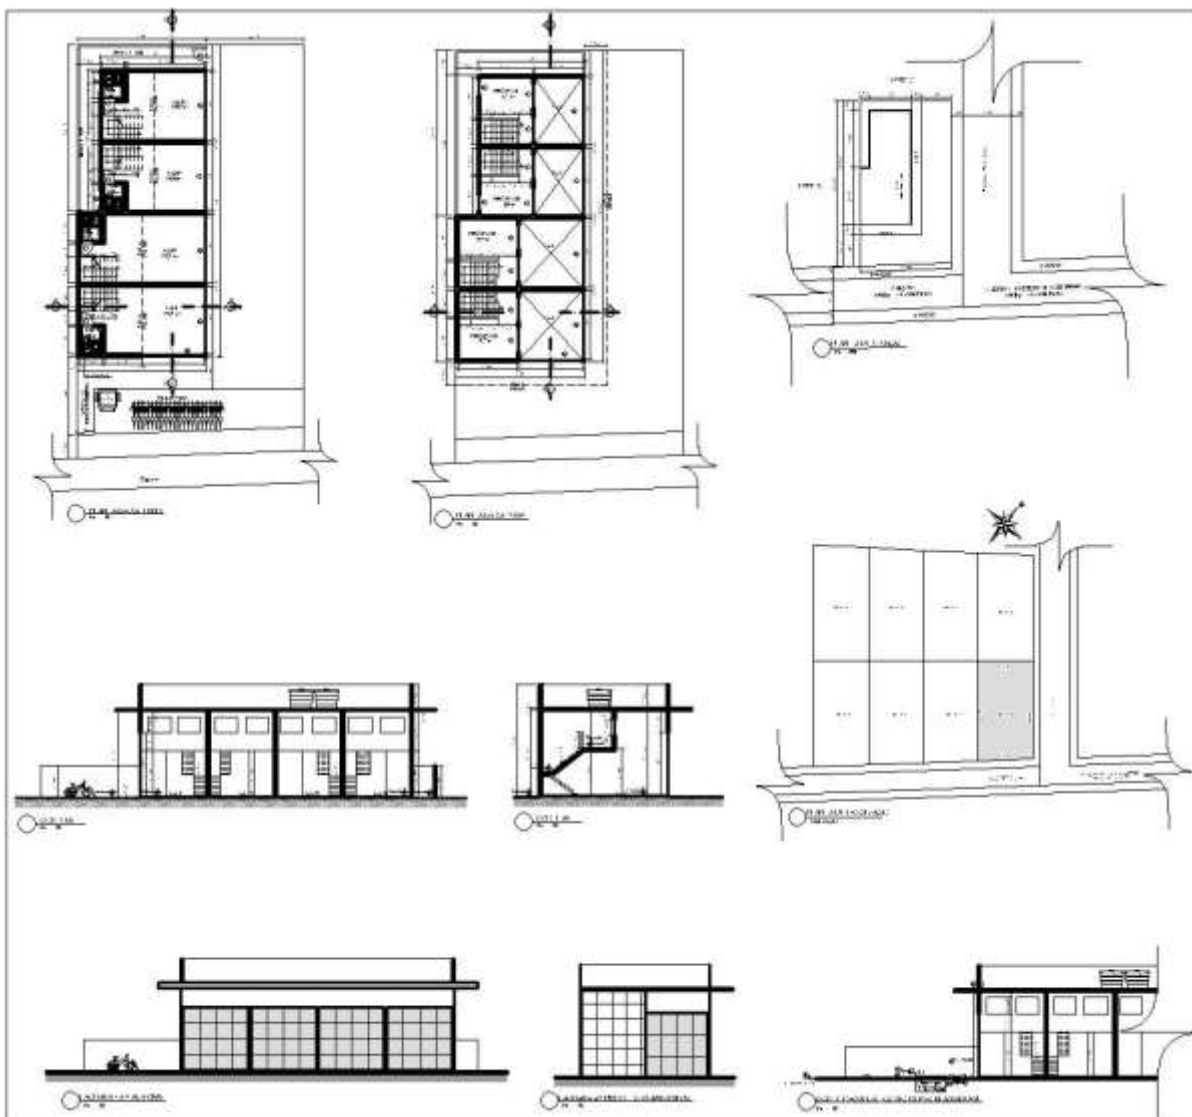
Planta baixa, cortes, fachada, cobertura e localização.
